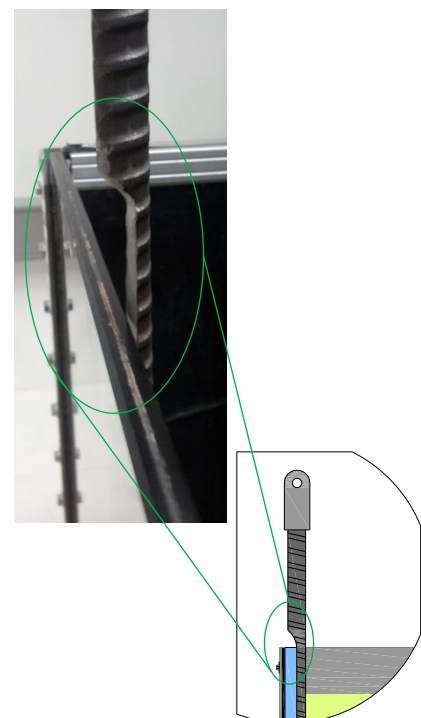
Detail Anschluss: Stab an Scheibe
